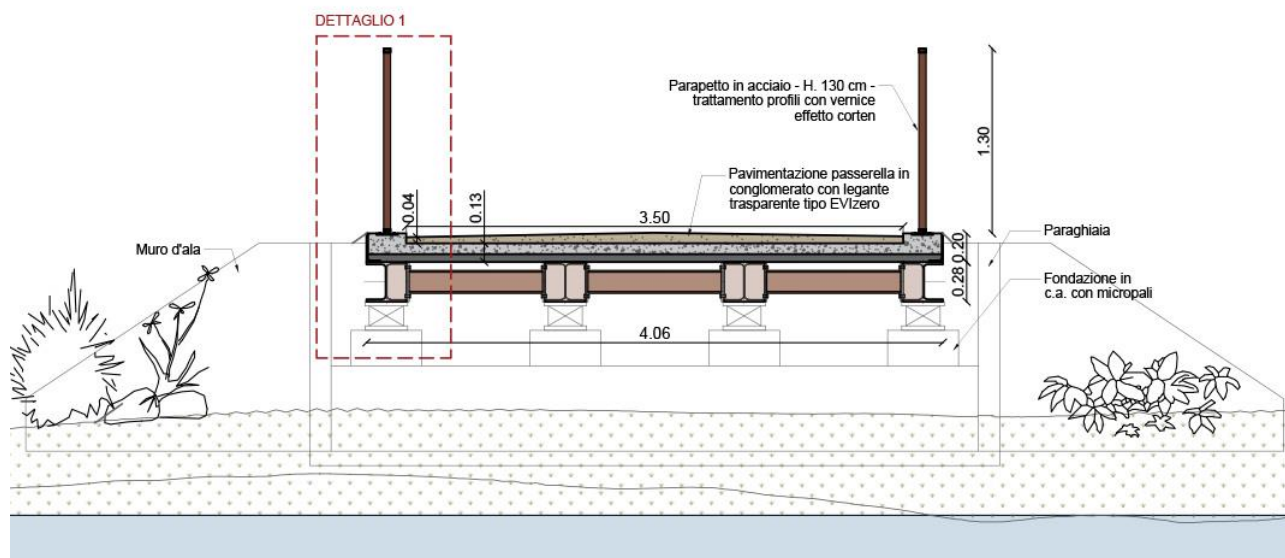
Sezione dell'impalcato tipo con l'indicazione della tipologia di pavimentazione adottata
